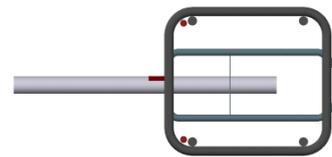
Disposición de armaduras de suspensión con cercos. Alzado.
